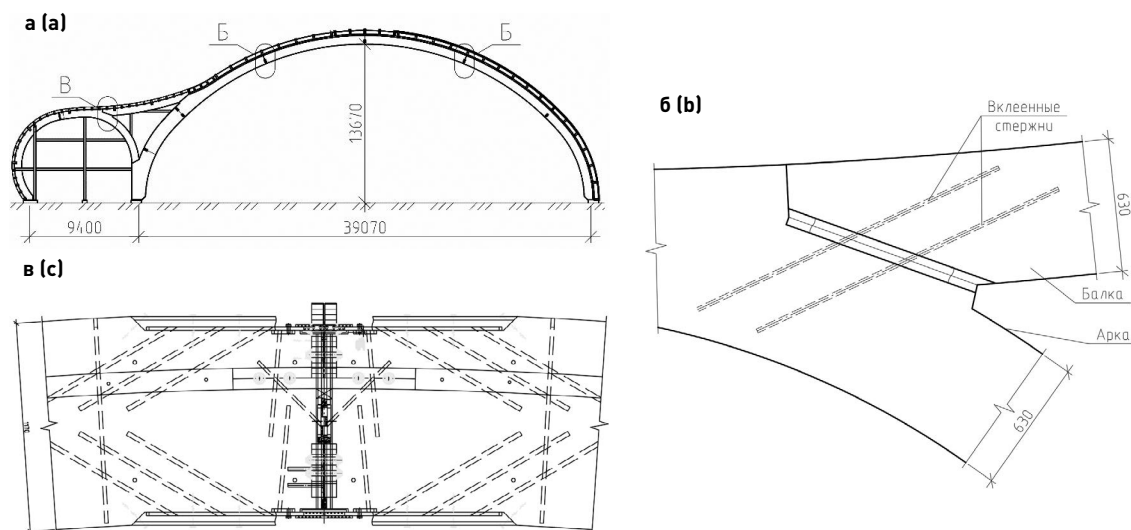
Схемы: а – каркаса здания центра; б – узла опирания на арку; в – жесткого стыка
